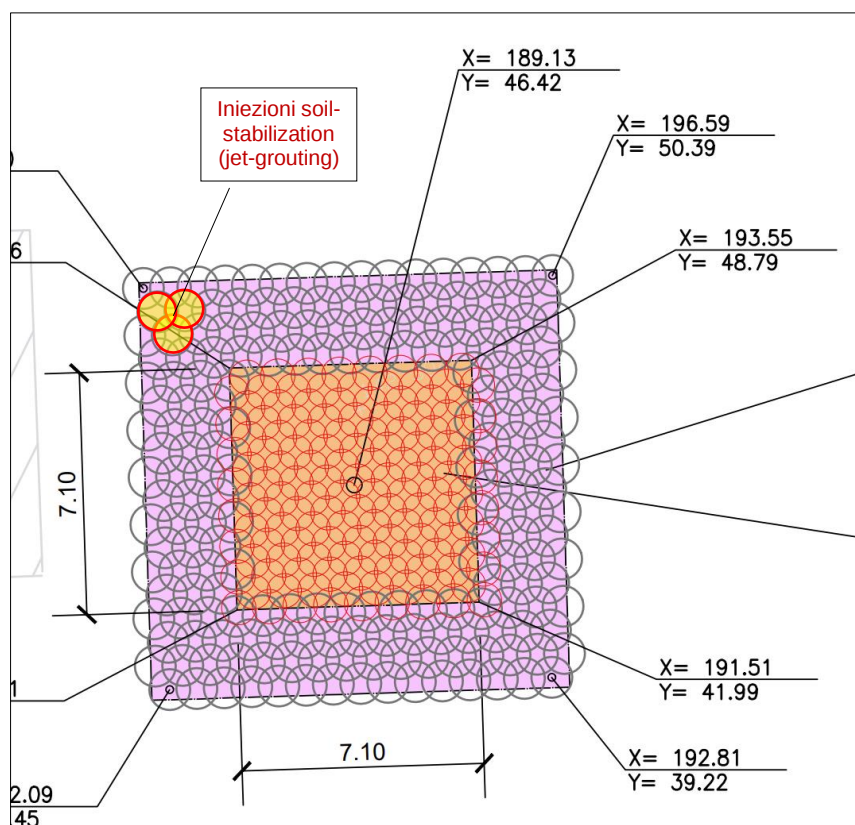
Ubicazione campo prova e colonne di jet-grouting
